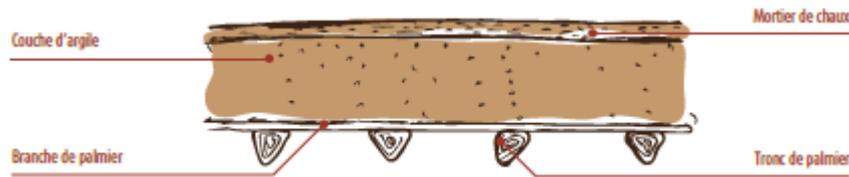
Planchers plats en troncs et branches de Palmiers
